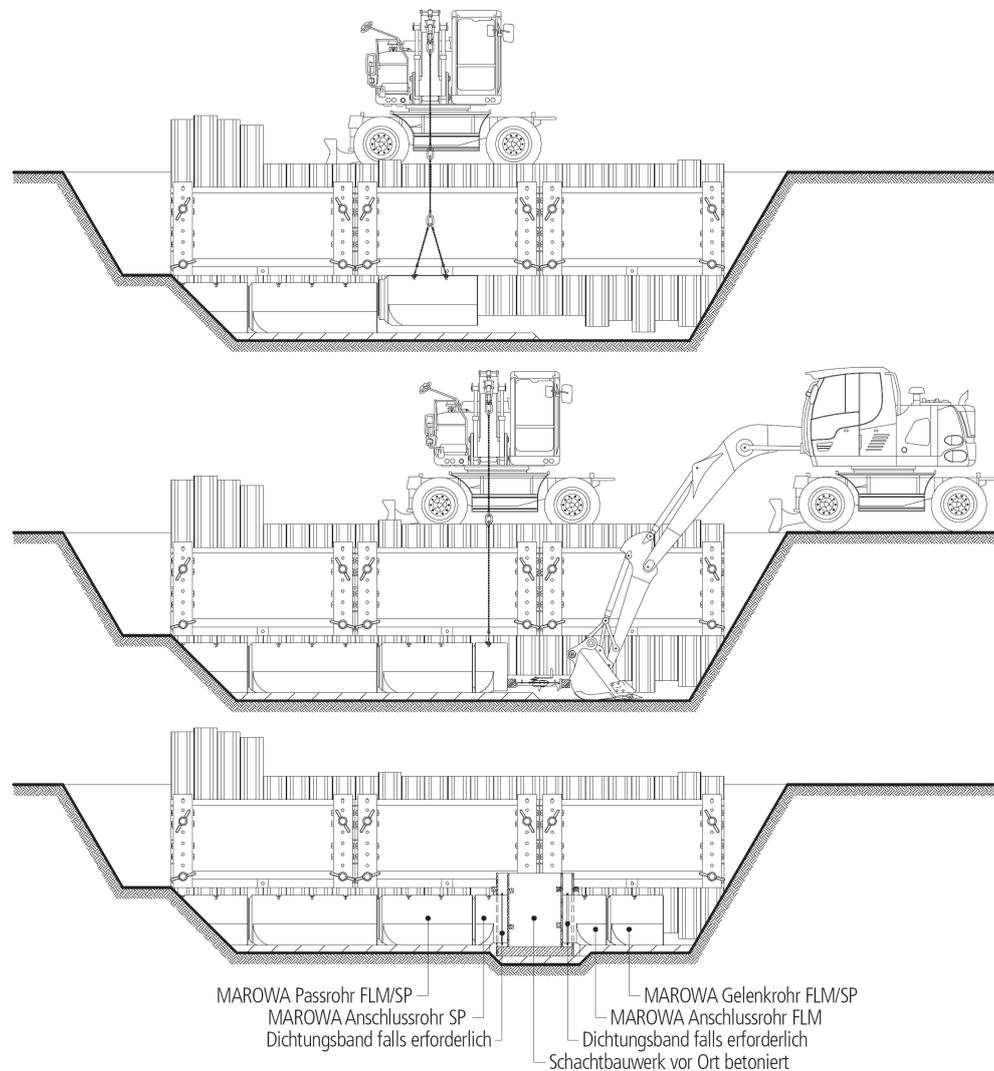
Möglicher Bauablauf bei Anschlüssen an Schachtbauwerke die vor Ort betonierte werden
